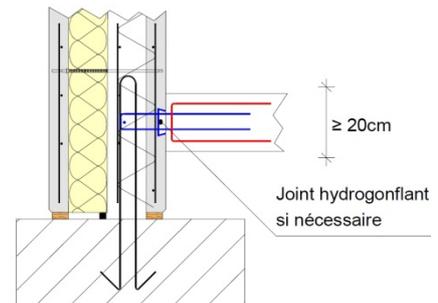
Liaison couturée avec plancher bas (boîte d'attente ou réservation horizontale pour attentes posées sur chantier)
